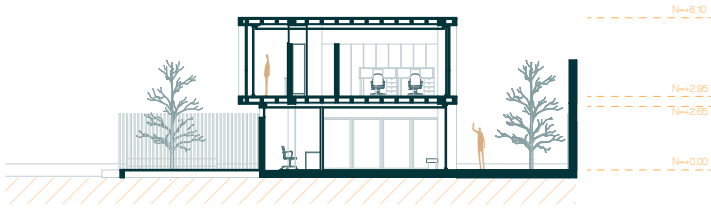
Sección B-B, Bloque A (Autores, 2023)
